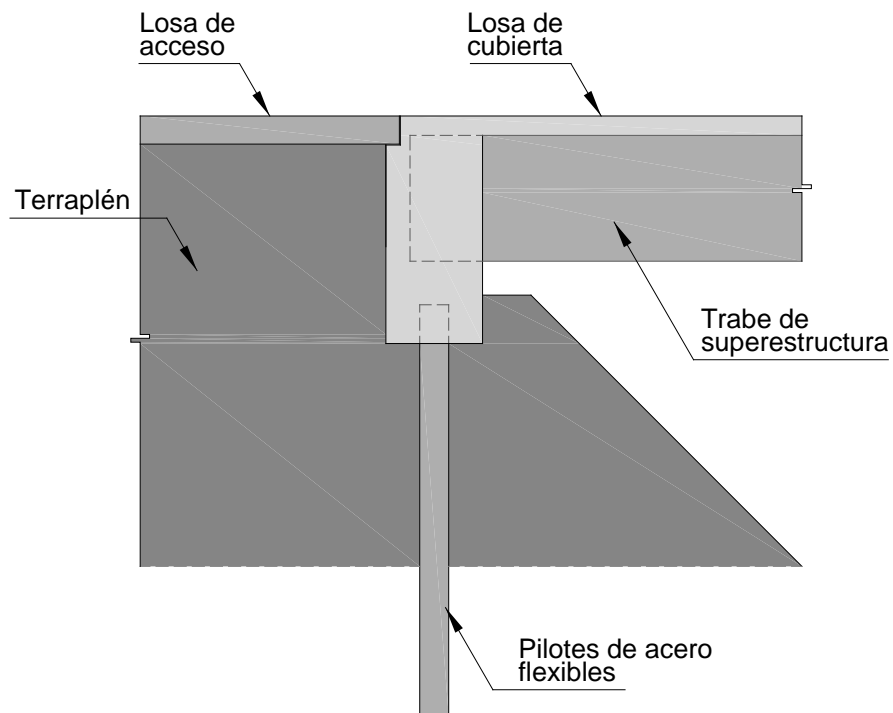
Estribo de puente integral – estribo apoyado en pilotes flexibles
